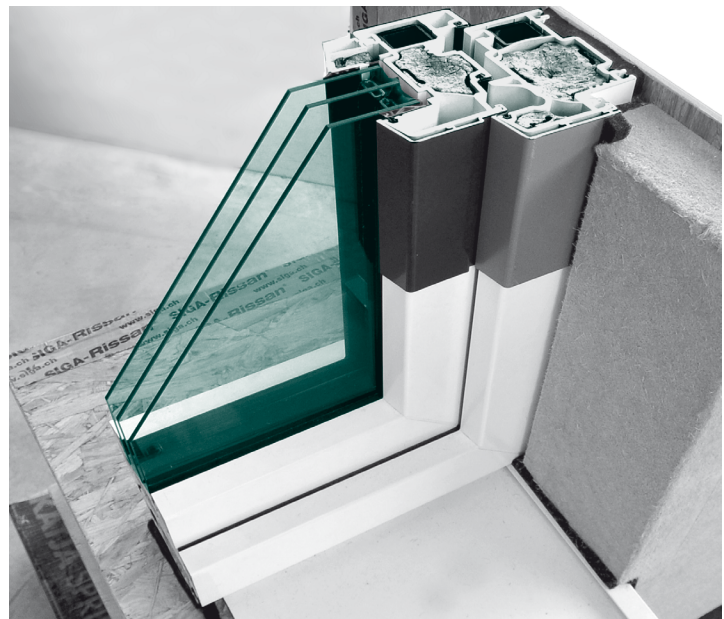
Detail der Fensterkonstruktion mit Erläuterung
